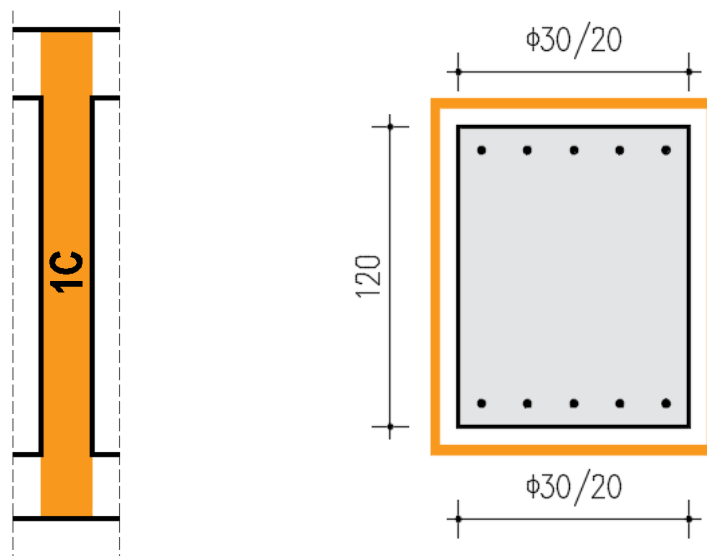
Differenziazione in zone dell'armatura principale a flessione e corrispettive viste in sezione
